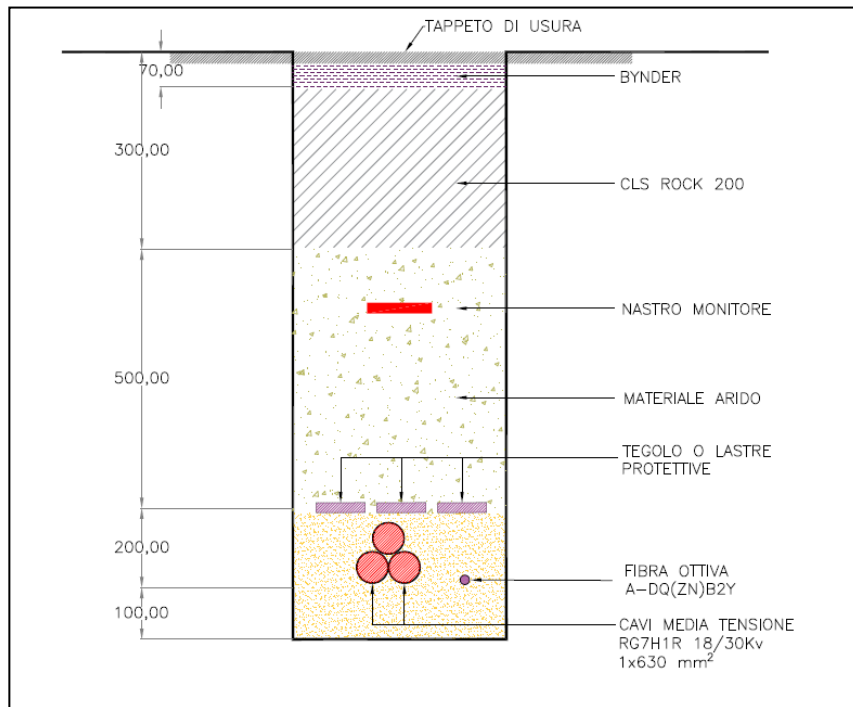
Sezione tipica di posa della linea in cavo su strada
